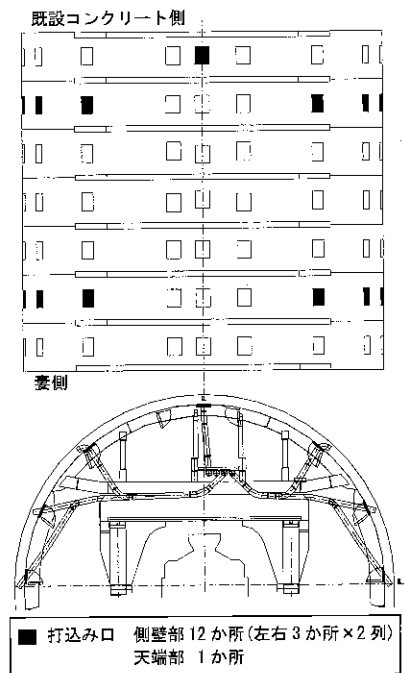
コンクリート打込み口の配置例(普通コンクリートの場合)
